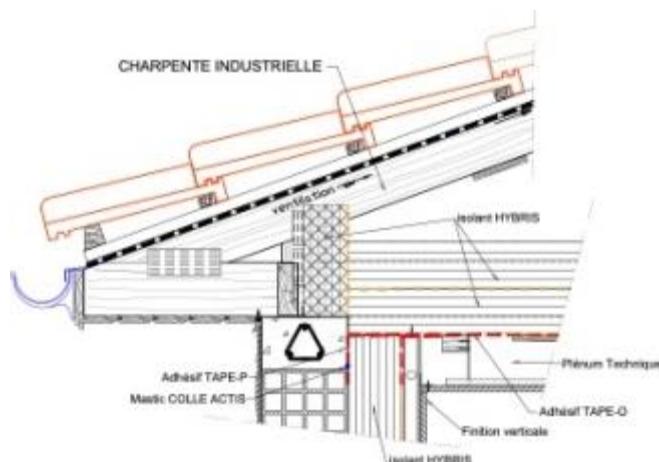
Isolation en combles perdus, sur plancher béton
